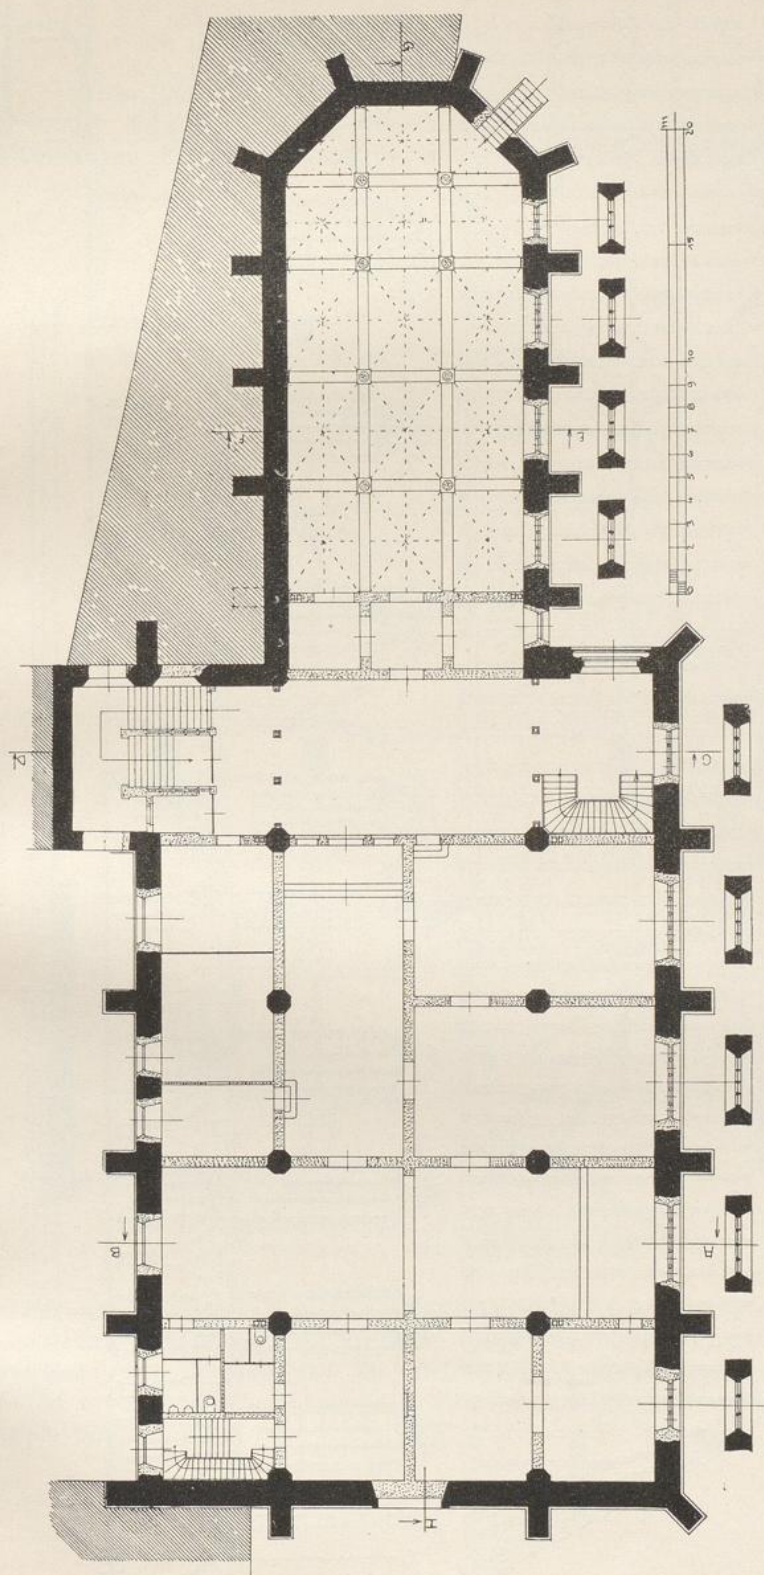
Hildesheim. Ehemalige Dominikanerklosterkirche St. Paul (jetzt Union). Grundriß des (jetzigen) Erdgeschosses.
